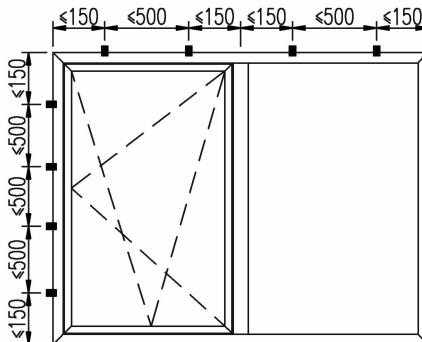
门窗框与附框、洞口安装固定点位置示意图
